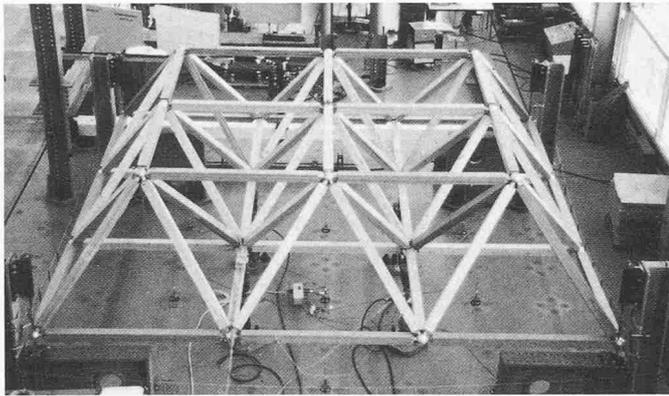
Raumfachwerk aufgebaut aus 2,4 m langen Stäben mit Querschnitt 120×120 mm; Tragkraft 1200 kN; hochbeanspruchte Stäbe in Buche
